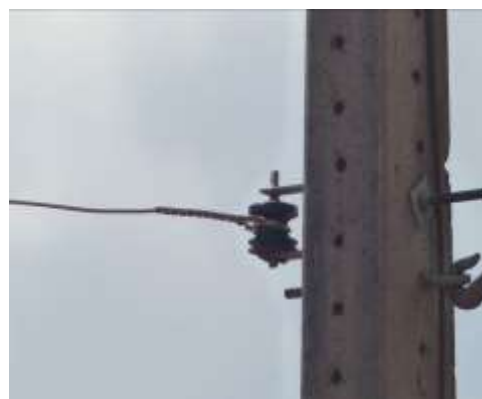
Conexão do neutro do ramal externo – SE Alexânia
